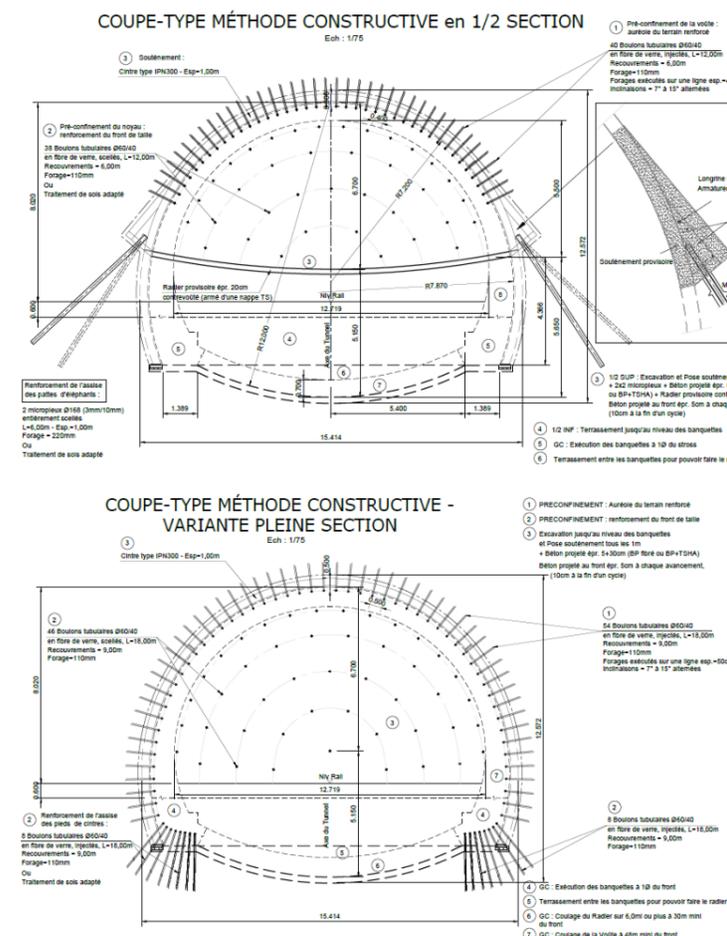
Coupes types méthodes constructives en demi et en pleine sections
